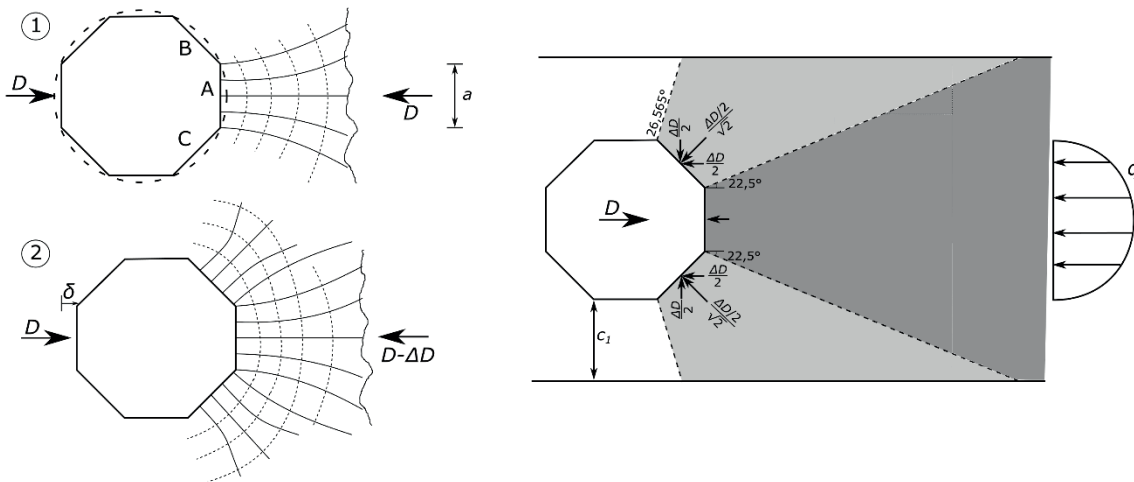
Querschnitt eines Glattstahlhakens vereinfacht mit achteckigem Grundriss und Druckbeanspruchung senkrecht zum Stab
